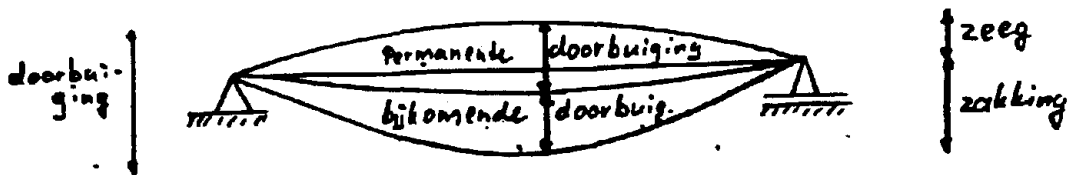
zeeg, zakking, bijkomende doorbuiging, permanente doorbuiging en doorbuiging.
